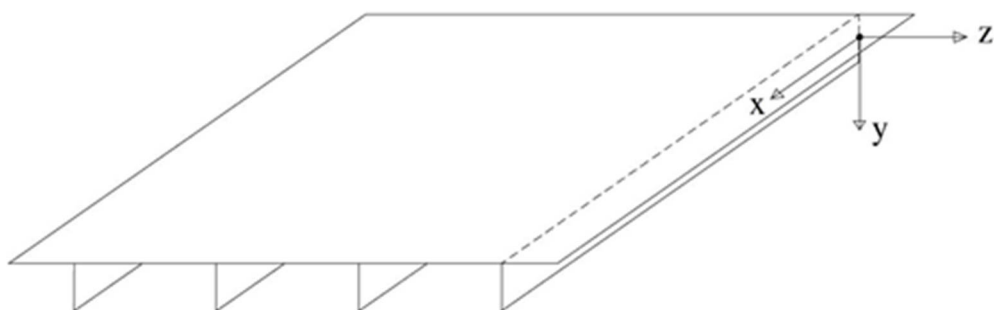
Superestrutura de uma ponte qualquer sem transversinas (STUCCHI, 2006)
